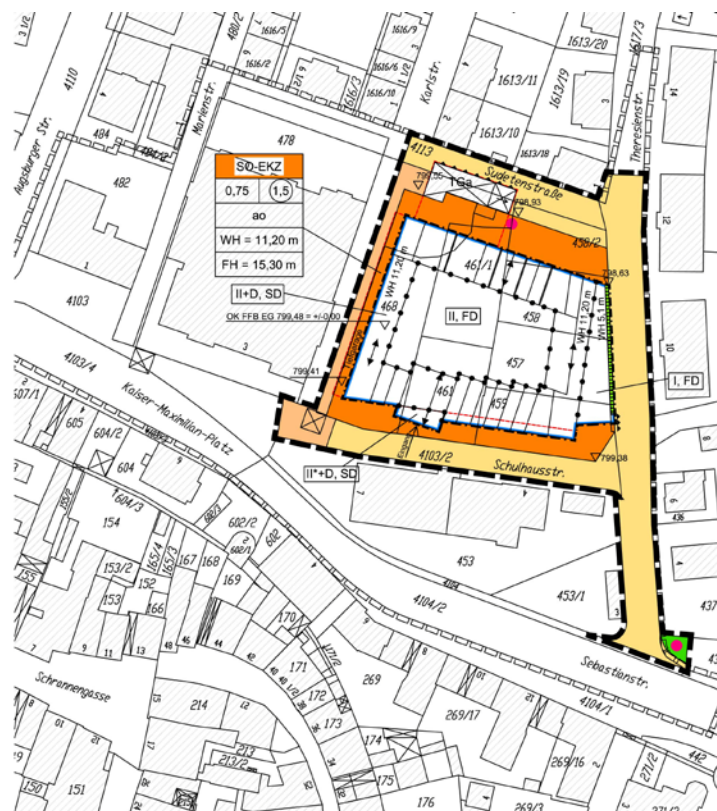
Planausschnitt des Bebauungsplanes mit Darstellung der Dachaufsicht, der Baugrenze und der Linie nach Planzeichen 15.3 der PlanzV.
